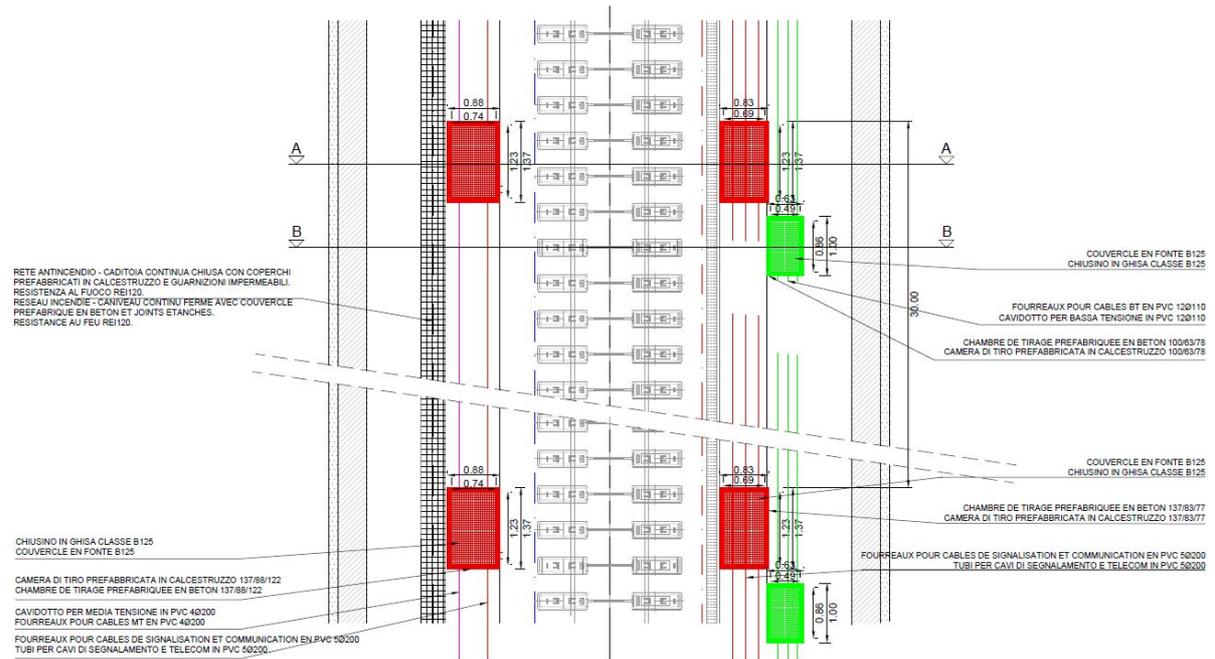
Planimetria delle camere di tiro e della rete antincendio
